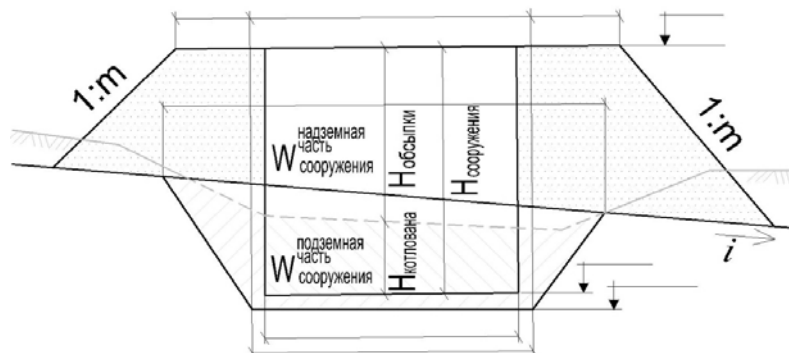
Схема устройства котлована и обсыпки сооружения (к расчету объемов земляных работ)
